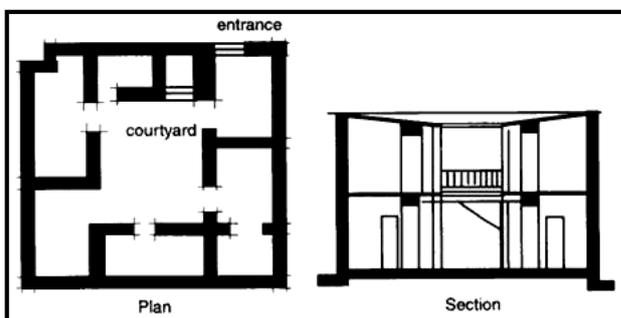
plan et coupe d'une maison de Ur, Mésopotamien
